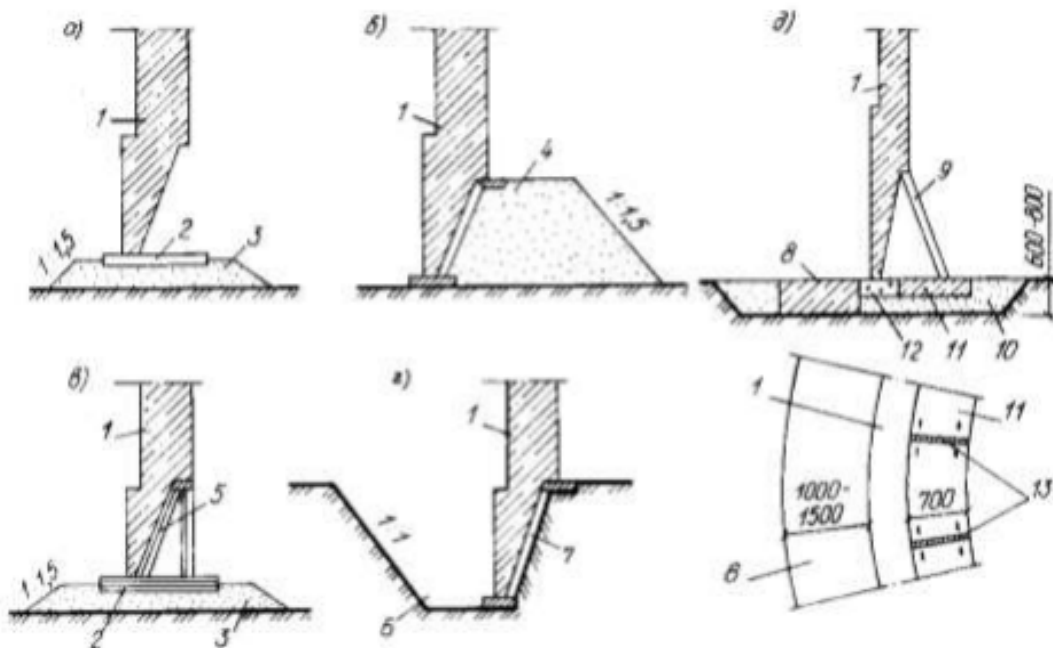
Схема встановлення ножа опускного колодязя на тимчасову основу: а – на піщану основу; б – підкладки із деревини; в – на насипній ґрунтовій чи щебінчатій призмі; г – на піщаній подушці та опорах із деревини; д – на опорному кільці із збірних залізобетонних елементів; 1 – ніж; 2 – підкладка із деревини; 3 – піщана подушка; 4 – ґрунтова призма; 5 – опора із деревини; 6 – траншея; 7 – опалубка із деревини чи залізобетонних плит; 8 – форшахту; 9 – опорна стійка; 10 – піщана засипка; 11 – опорне кільце із збірних залізобетонних блоків; 12 – ущільнена щебінка; 13 – розподільчі дошки
